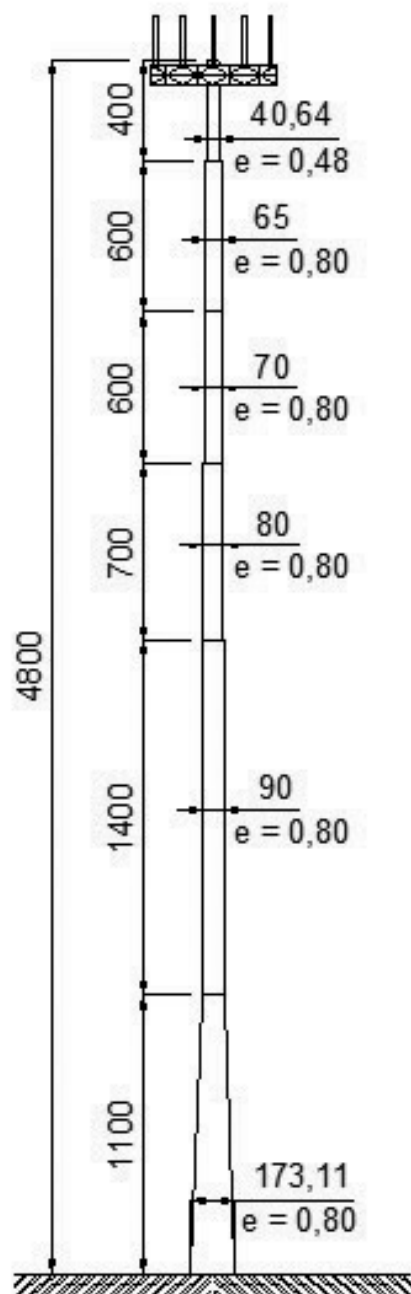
Estrutura 1: Geometria - Medidas em centímetro.
